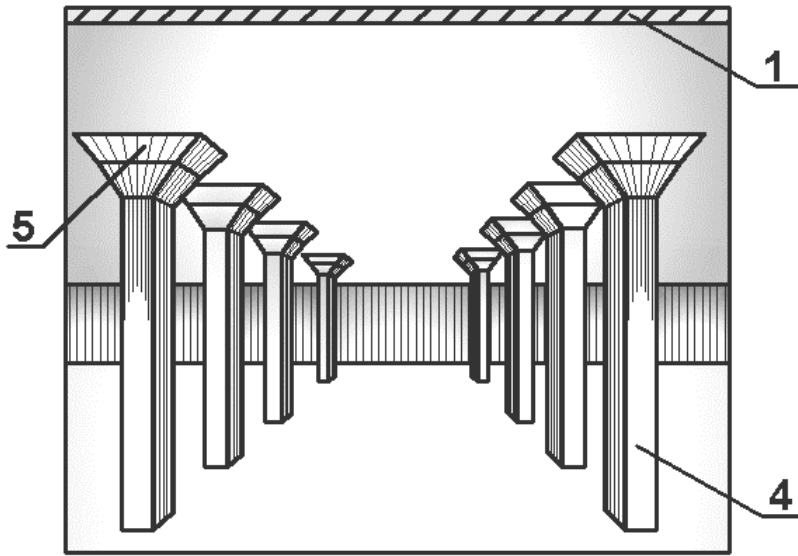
Будівництво будівлі з плоским безбалковим перекриттям.
